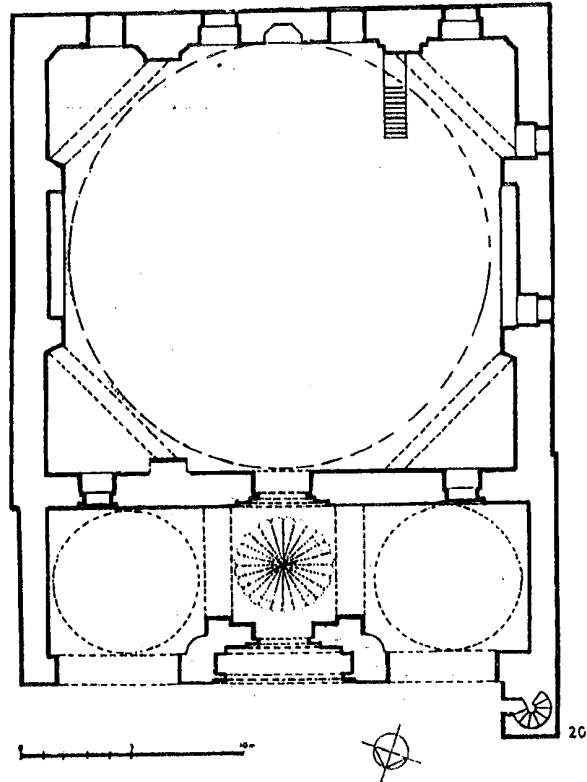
مسقط أفقي لمسجد علاء الدين بك
